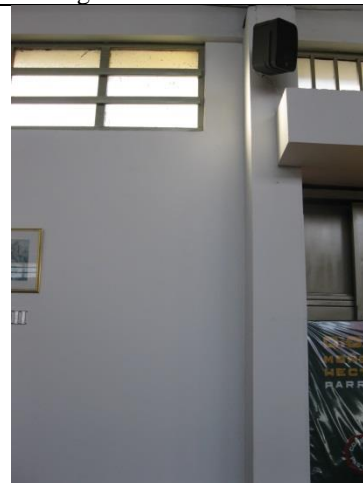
Grietas en muros y efectos de columnas corta
